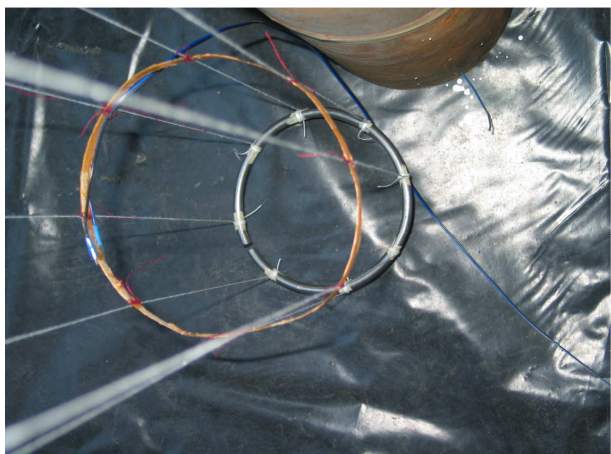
Tensometry pierścieniowe w serii C.
